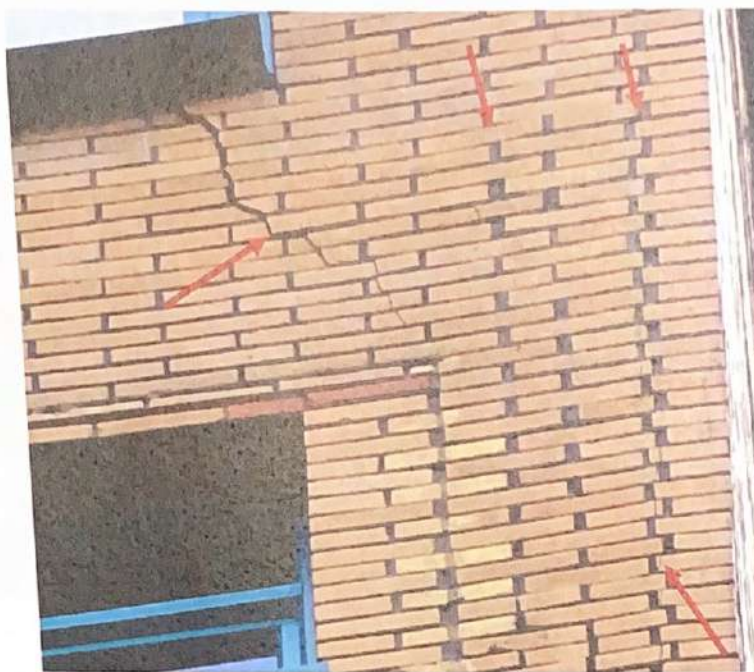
Секция 10. Фасад 2. Межсекционный деформационный шов не доходит до верха здания – причина разрушения вышележащей кладки. Диагональные трещины. Разрушение кладки над оконными балками. Деталь.
